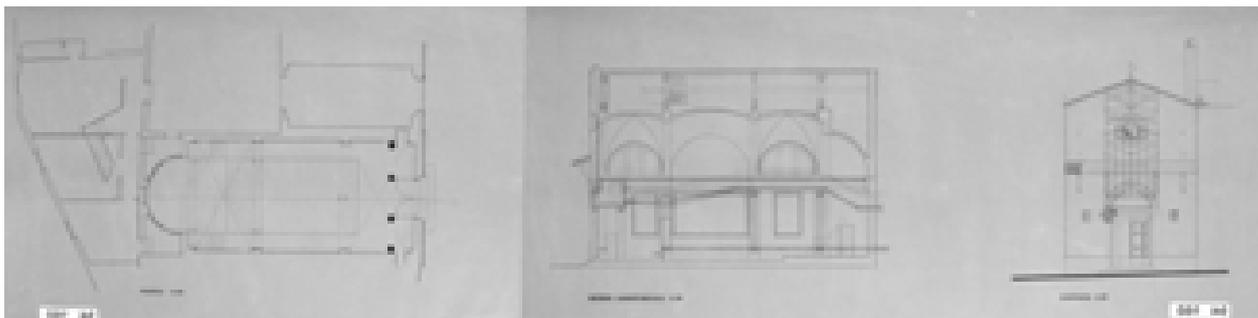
San Leonardo studio per museo e archivio, pianta prospetti sezioni – s.d. (AABS-94.0160)
